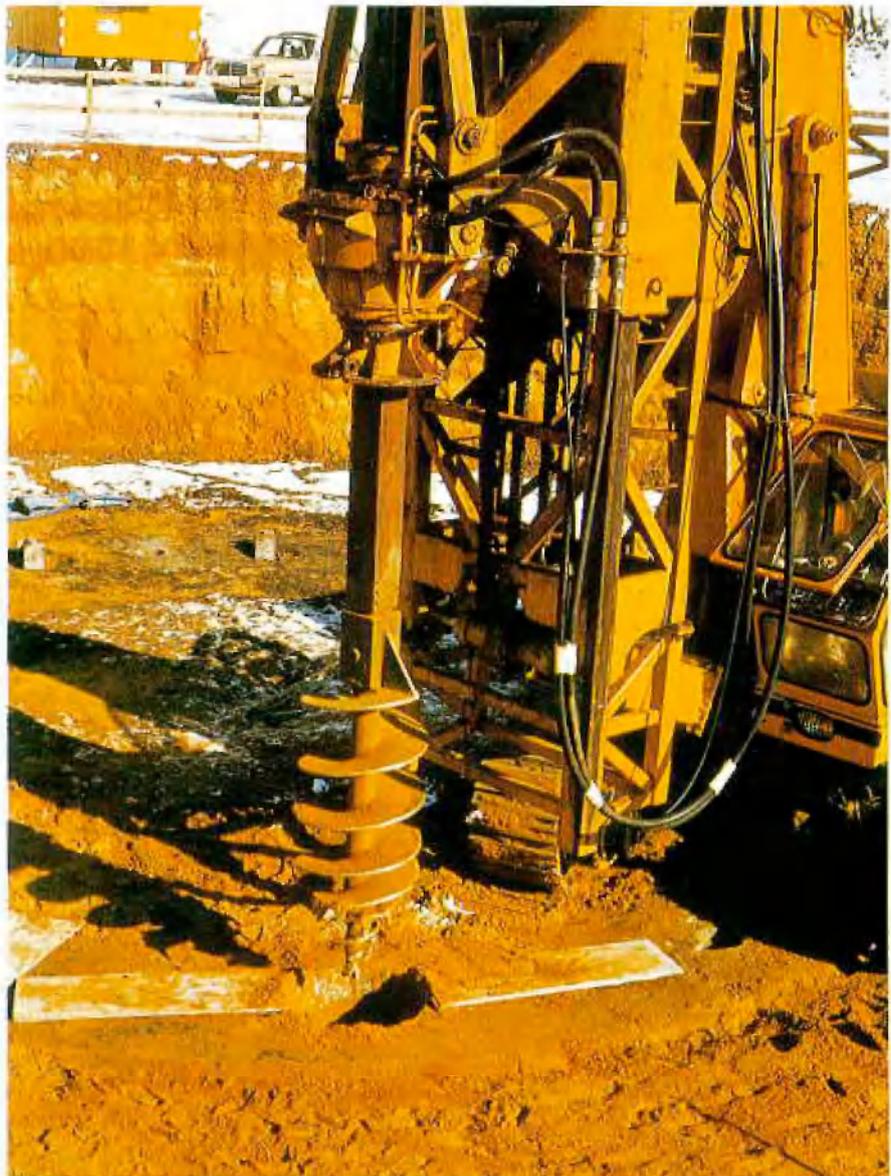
Bohrerät – Das Bild zeigt die hydraulisch angetriebenen Schneckenbohrer mit Gestänge an der Lafette des Geräts
